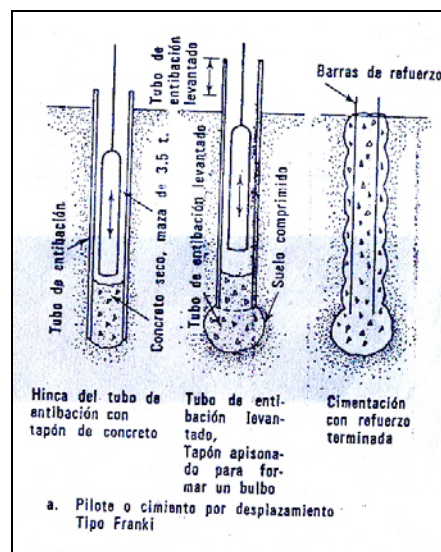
Pilotes especiales sin tubo de entibación permanente
